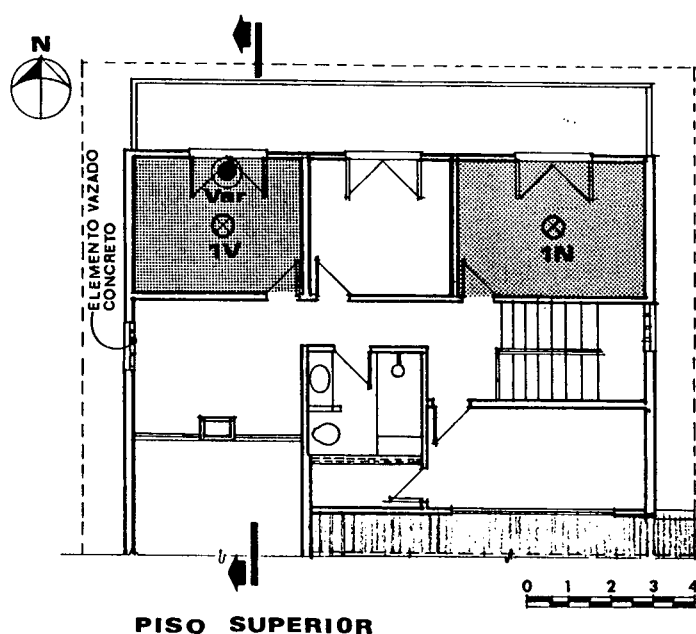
Casa dos Ingleses, planta baixa piso superior
